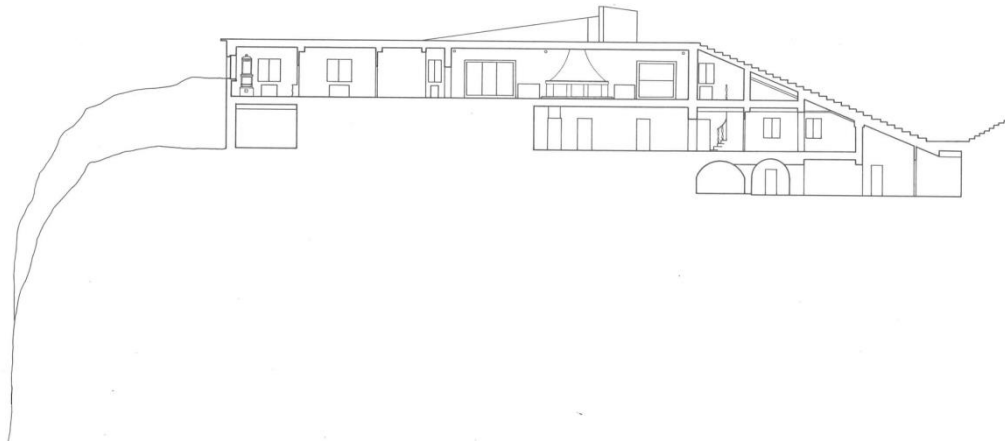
Casa Malaparte*, 1937, Adalberto Libera. Sección longitudinal. Acceso al plano superior desde el exterior.
